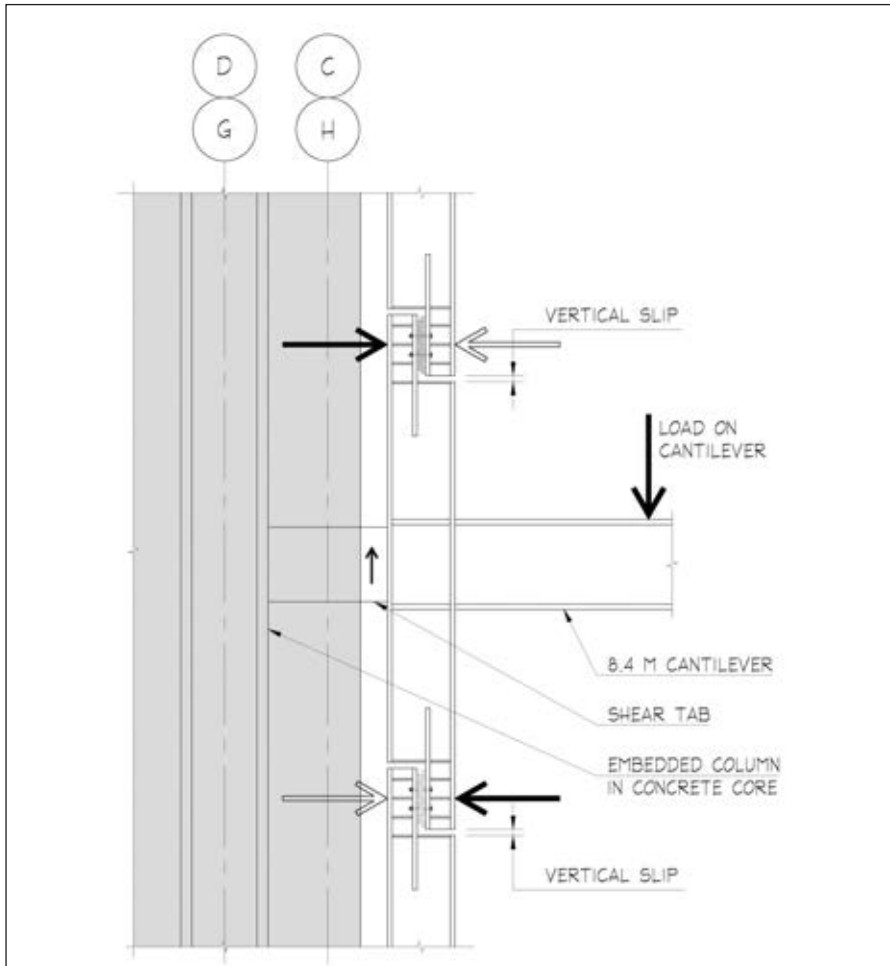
Las cargas gravitatorias del entramado de forjado en voladizo son soportadas mediante una unión a los muros del núcleo simplemente resistente a cortante. La coacción al momento flector la proporcionan el pilar de acero adyacente al muro del núcleo.
